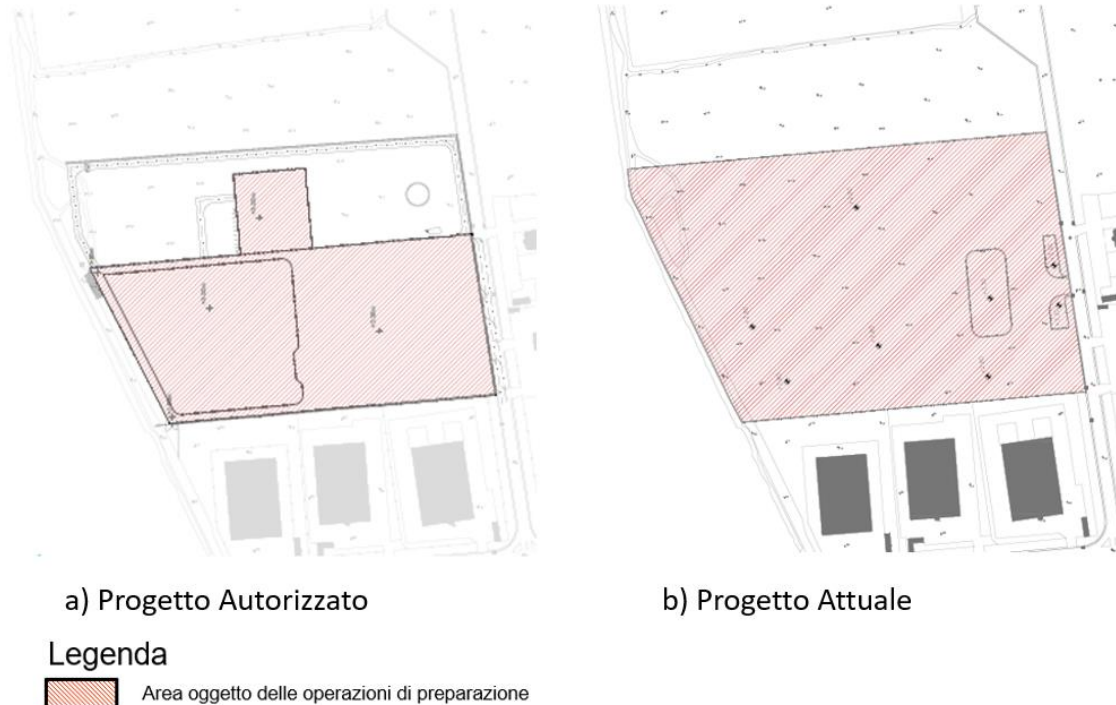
Attività 1 - Aree Oggetto delle Operazioni di Preparazione (Progetto Autorizzato e Progetto Attuale)
